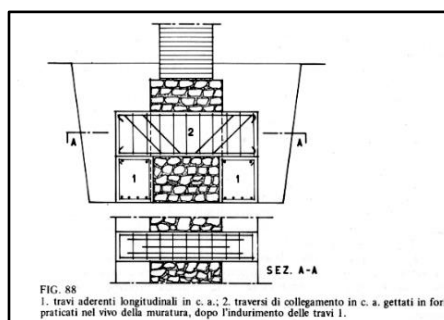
Elargissement de la fondation avec semelle en béton armé
